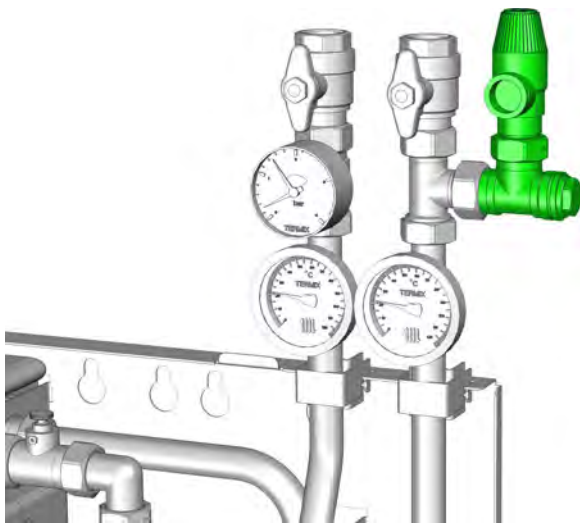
Skrutkové spoje pre primárnu stranu
